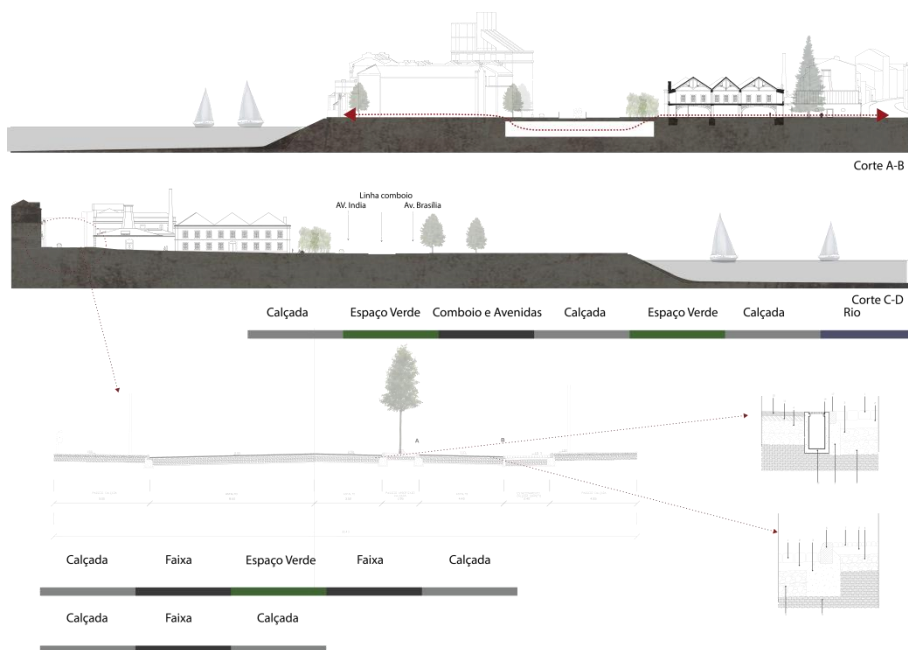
Cortes transversais desde a Rua da Junqueira, até ao rio, com pormenores construtivos da rua.
